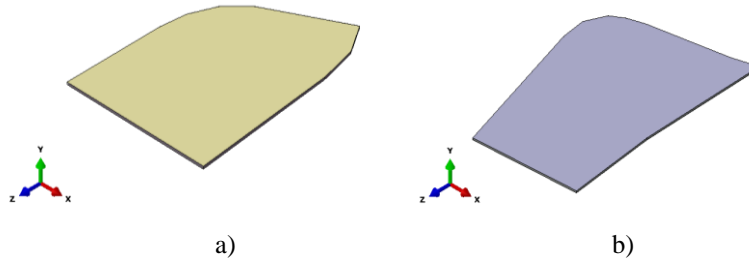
Joints ajoutés dans les liaisons entre la poutre et le support : P8 (a) et P9 (b), (repère de la poutre)
